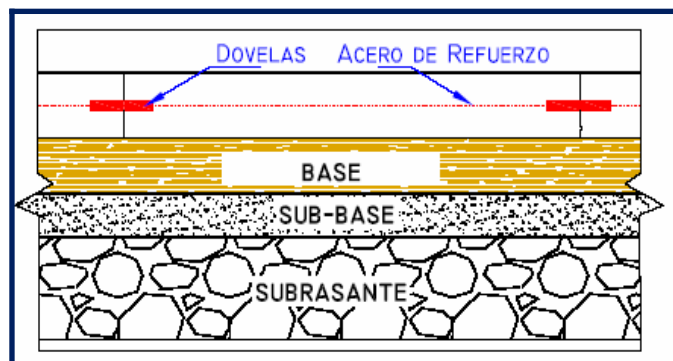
Loza de concreto reforzado (Vista en perfil)
